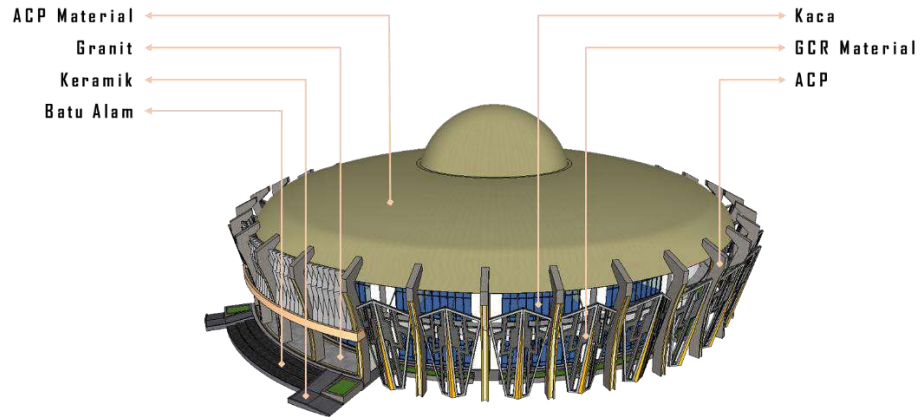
27 : Konsep Struktur Atas Pada Bangunan Mess.
